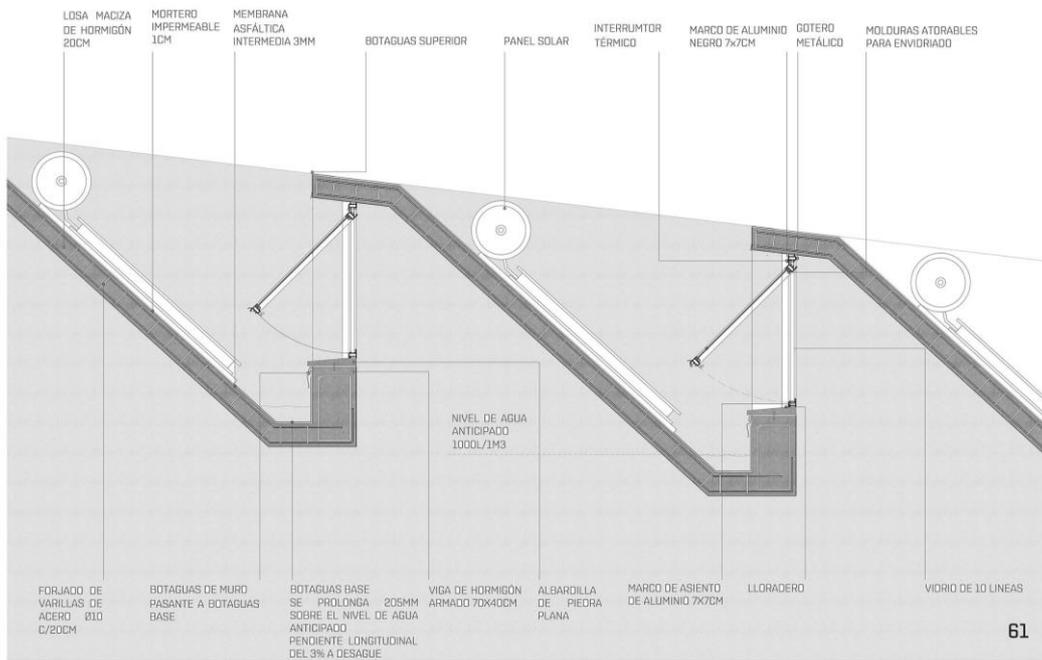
Detalle constructivo cubierta inclinada. Elaborado por: María Beatriz Moncayo
